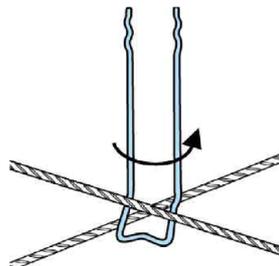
Anstecknadel nach links über unteren Bewehrungsstab drehen.
